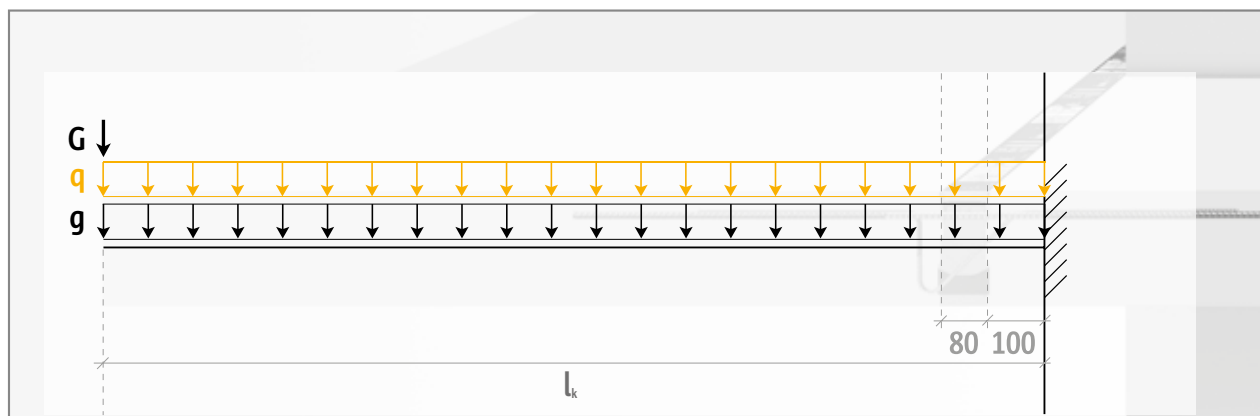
Schöck Isokorb® tipo K, schema statico ed ipotesi di carico
